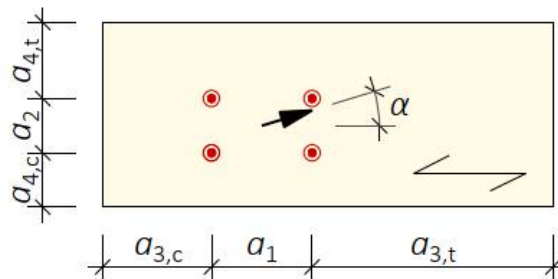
Mindestabstände rechtwinklig zur Schraubenachse beanspruchter Schrauben
